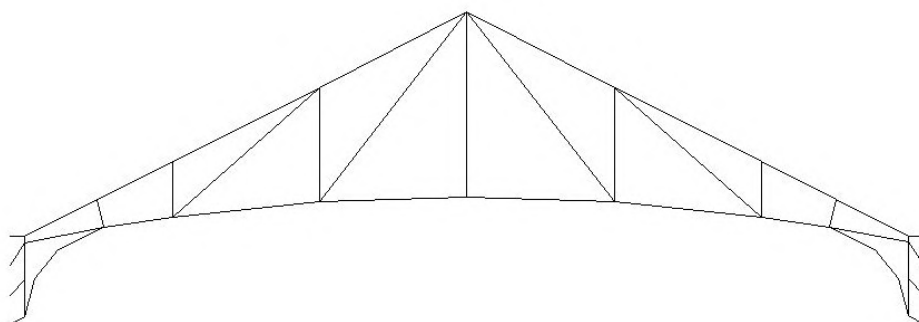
Travessa da cobertura do ginásio - treliça metálica
